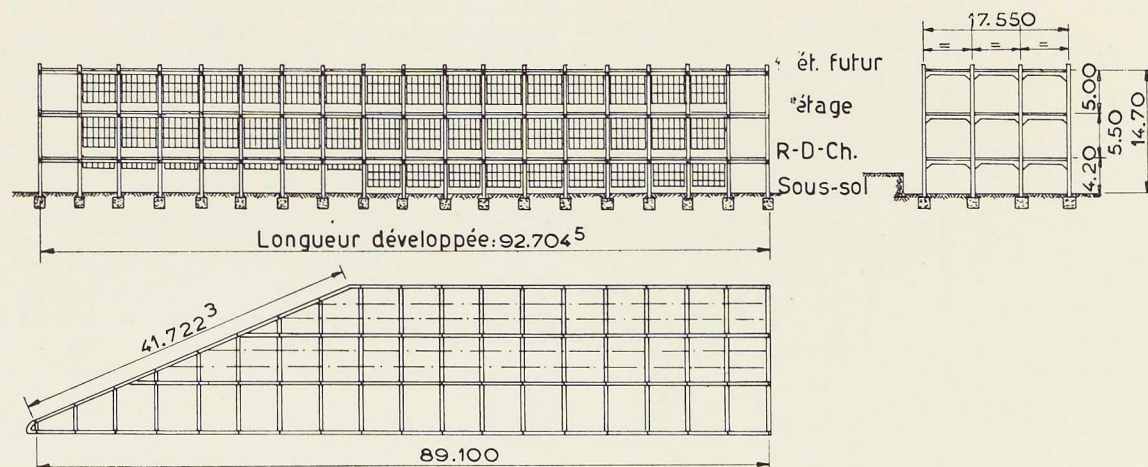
S. A. Baume et Marpent. Coupe longitudinale et transversale et plan de l'ossature
